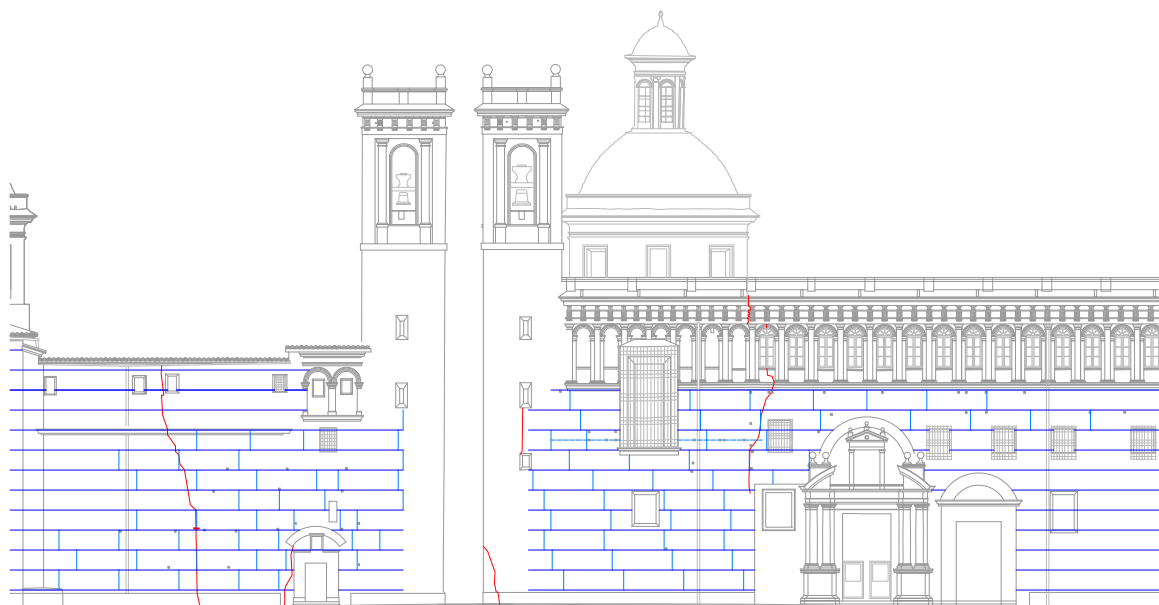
Detalle de la tapia, con algunas juntas verticales, y las fisuras más evidentes.
